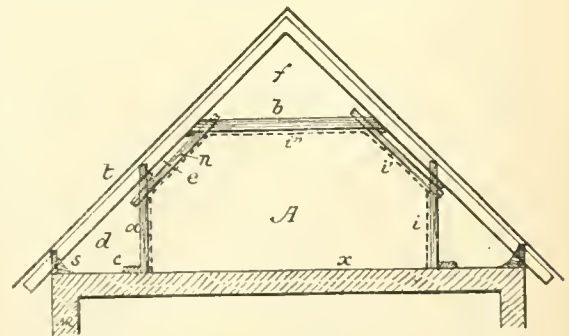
Coupe verticale d'une pièce lambrissée avec caissons isolants.
